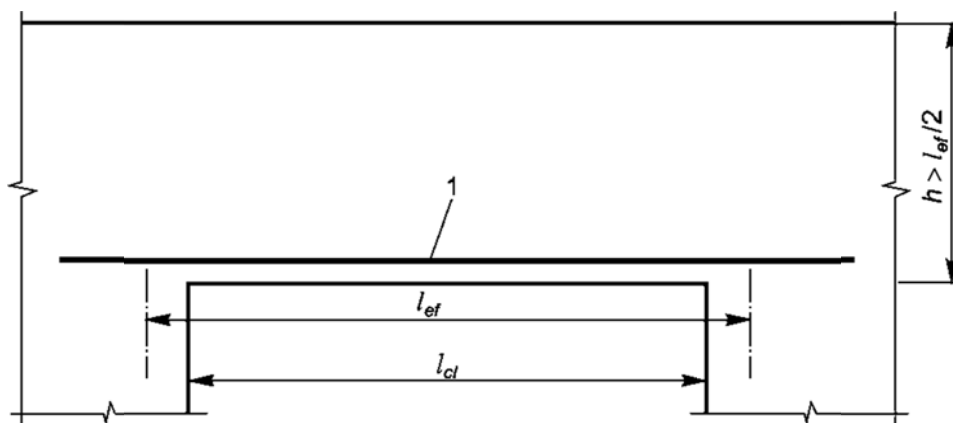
Расчетный (эффективный) пролет балки-стенки:
